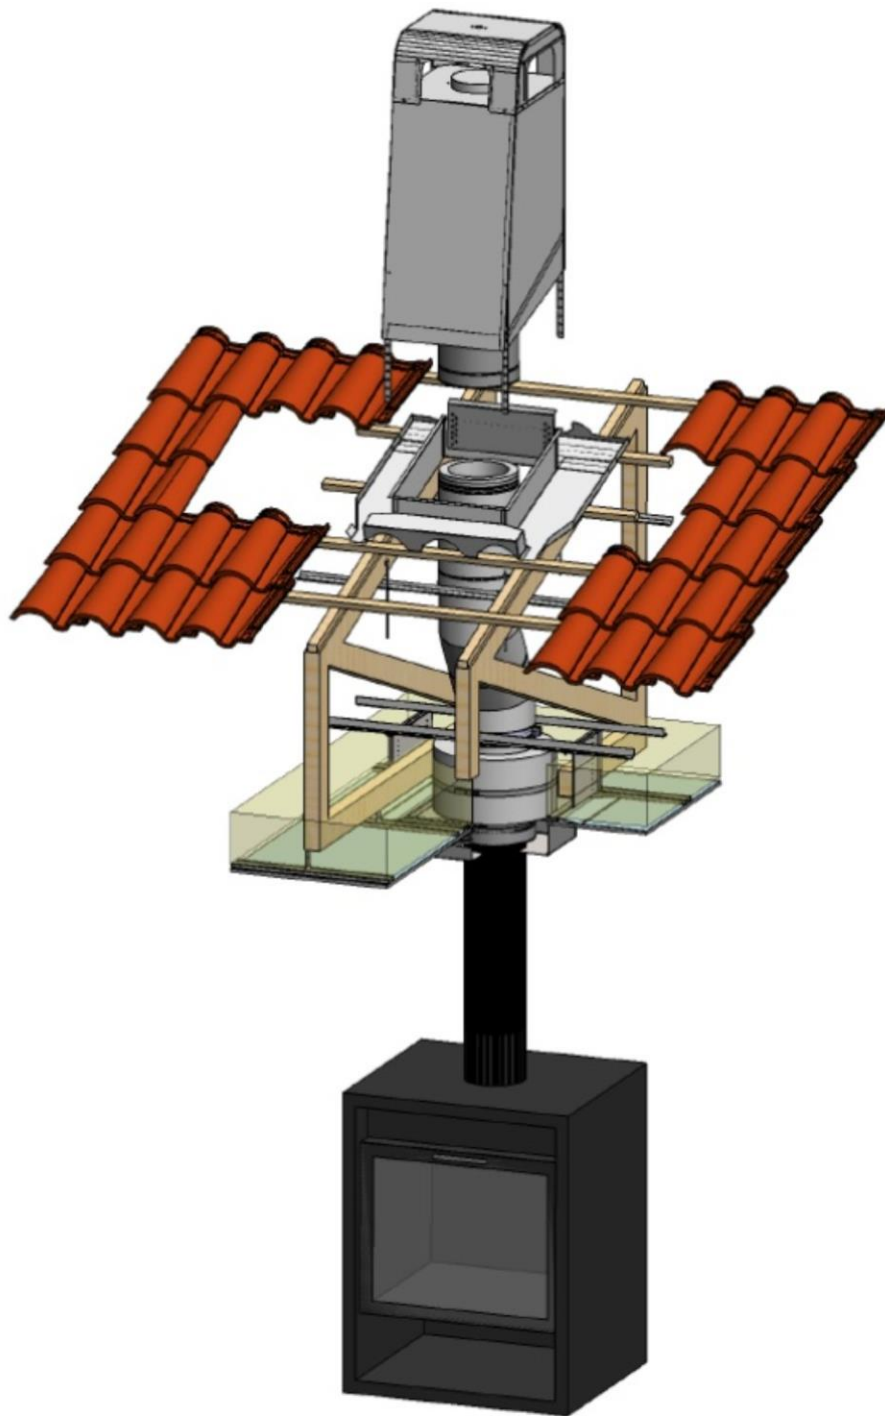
Schéma de mise en œuvre en traversée de plancher (maison de plain-pied, plafond horizontal)
